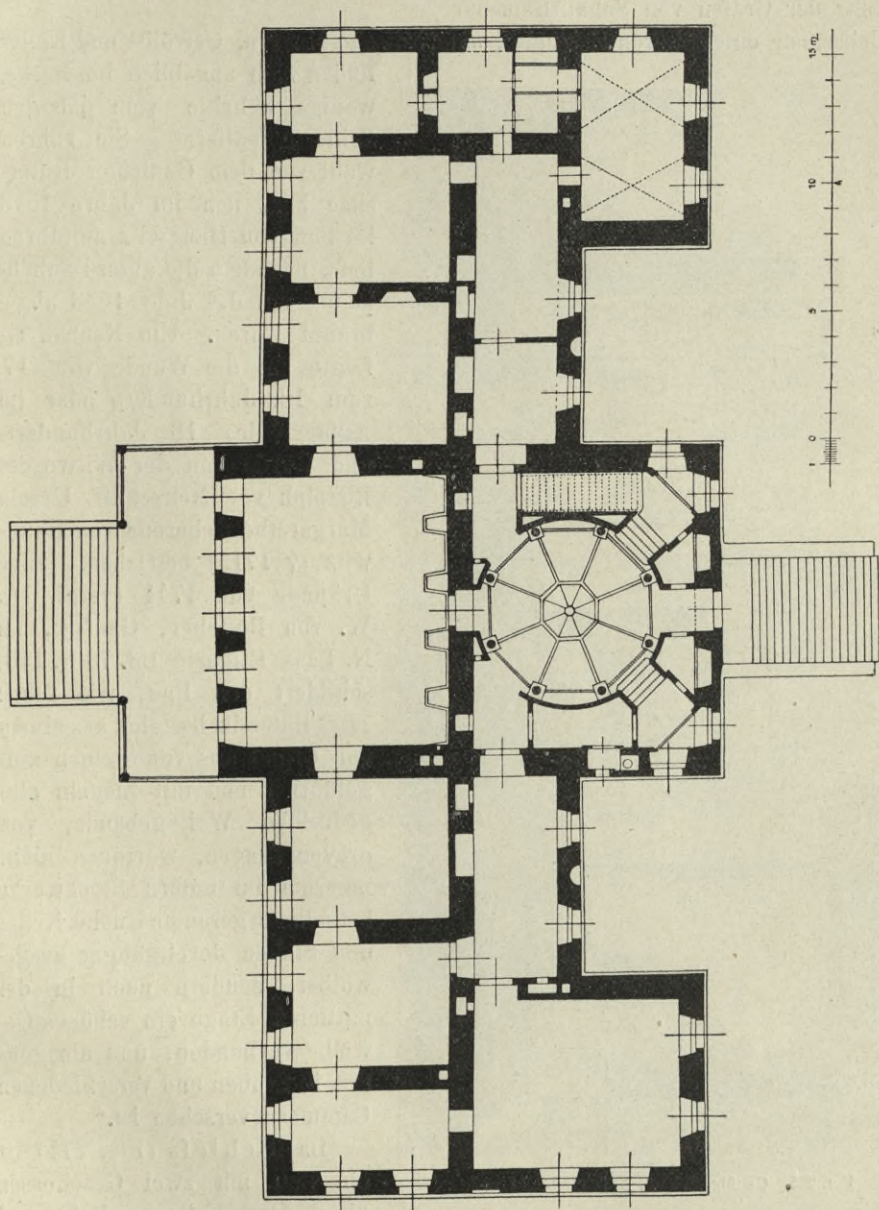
Gaußig, Schloß, Grundriß des Erdgeschosses.
